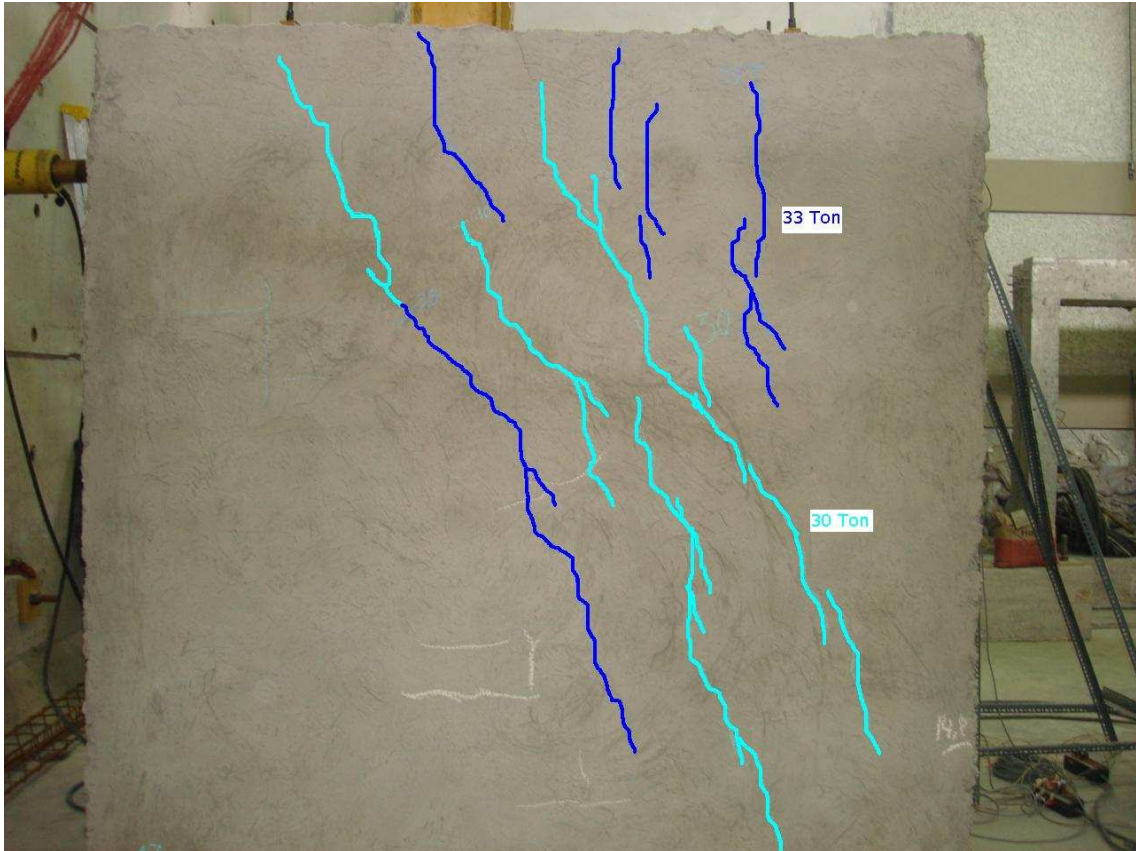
Fisuras en el interior de la pared las 30 t de carga positiva
